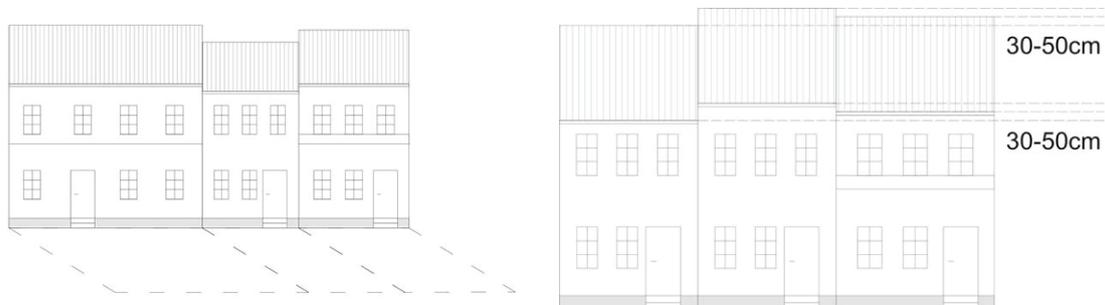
Gebäude orientieren sich an der bestehenden Parzellenstruktur
